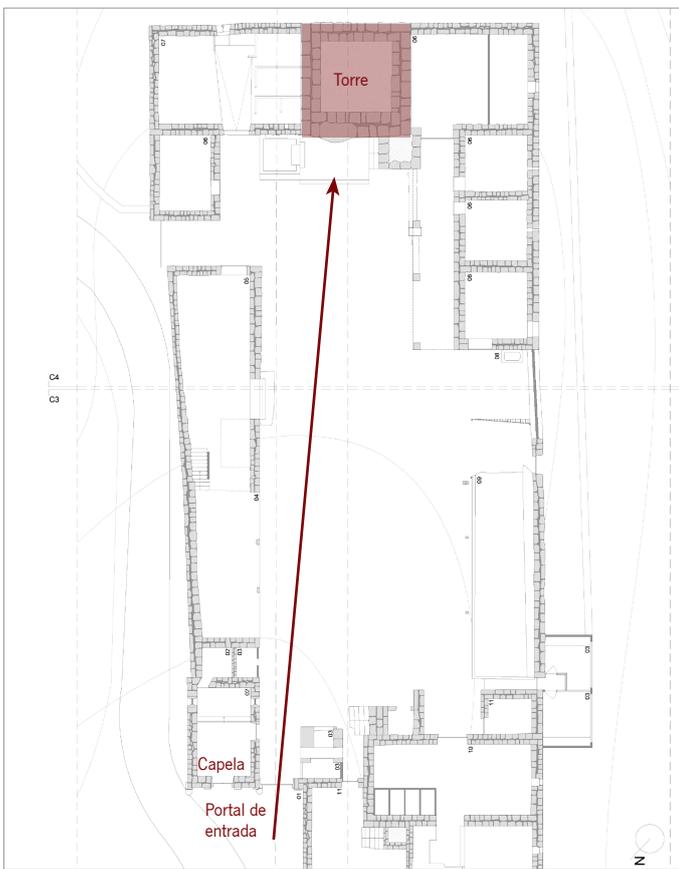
Planta do Piso 0 do conjunto edificado da Torre de Dornelas (Esc. 1:500)
